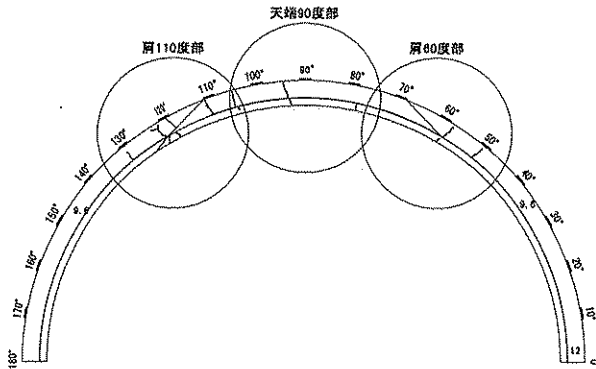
供試体上面で観察したひび割れ状況図
